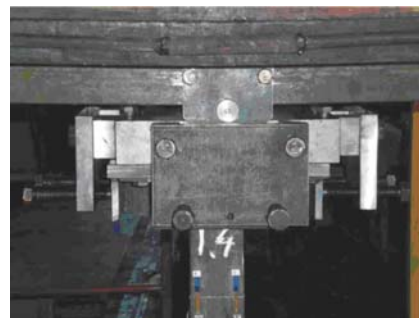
Общий вид опорных приспособлений, устанавливаемых на прокатных образцах [8] в верхней части
